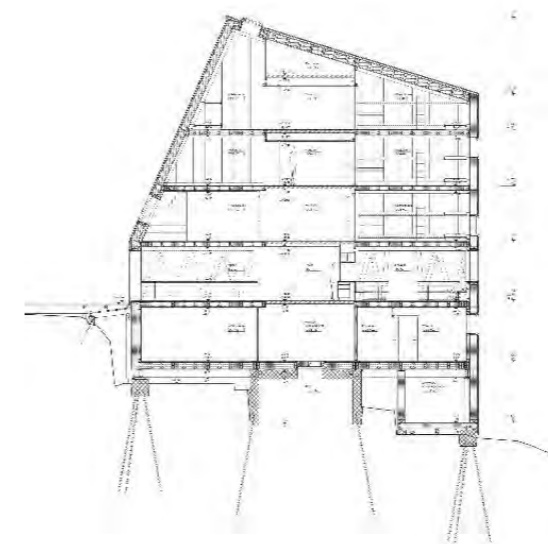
Sezione trasversale Monte Rosa Hutte.
